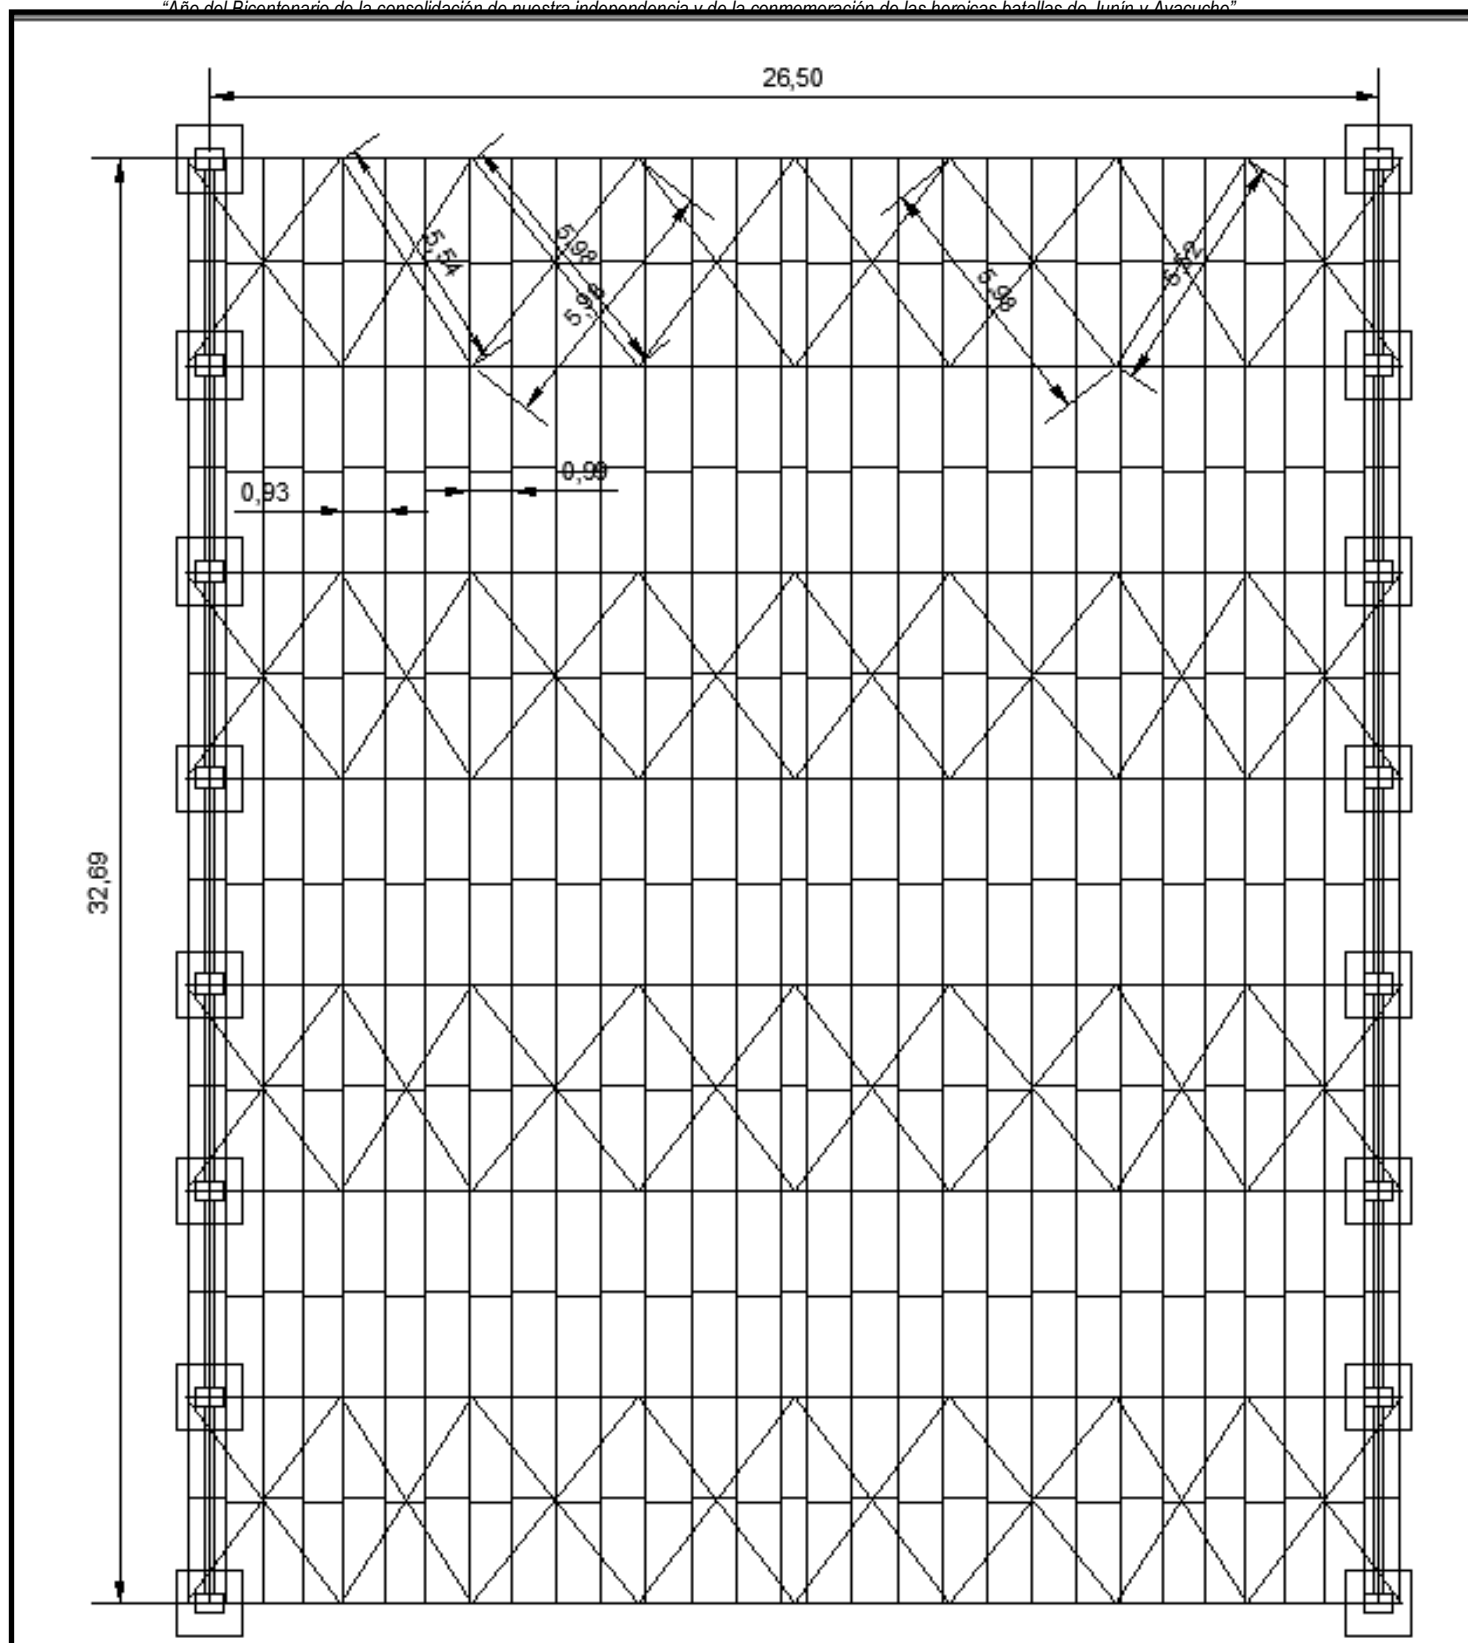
IMAGEN: CORTE DE DETALLES DE CERCHA TIPO CIRCULAR //
